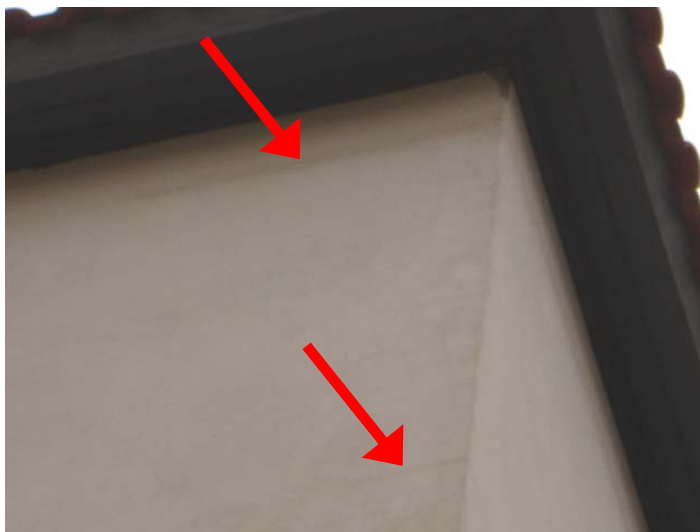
fissuras horizontais localizadas na fachada da edificação
